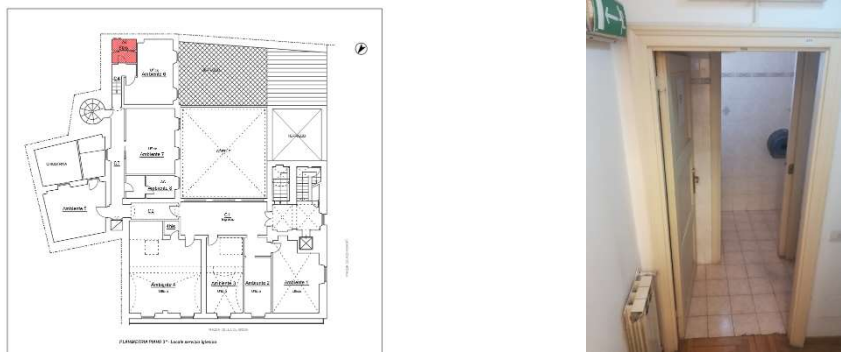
Planimetria piano terzo Palazzo Ossoli: servizio igienico da rinnovare
